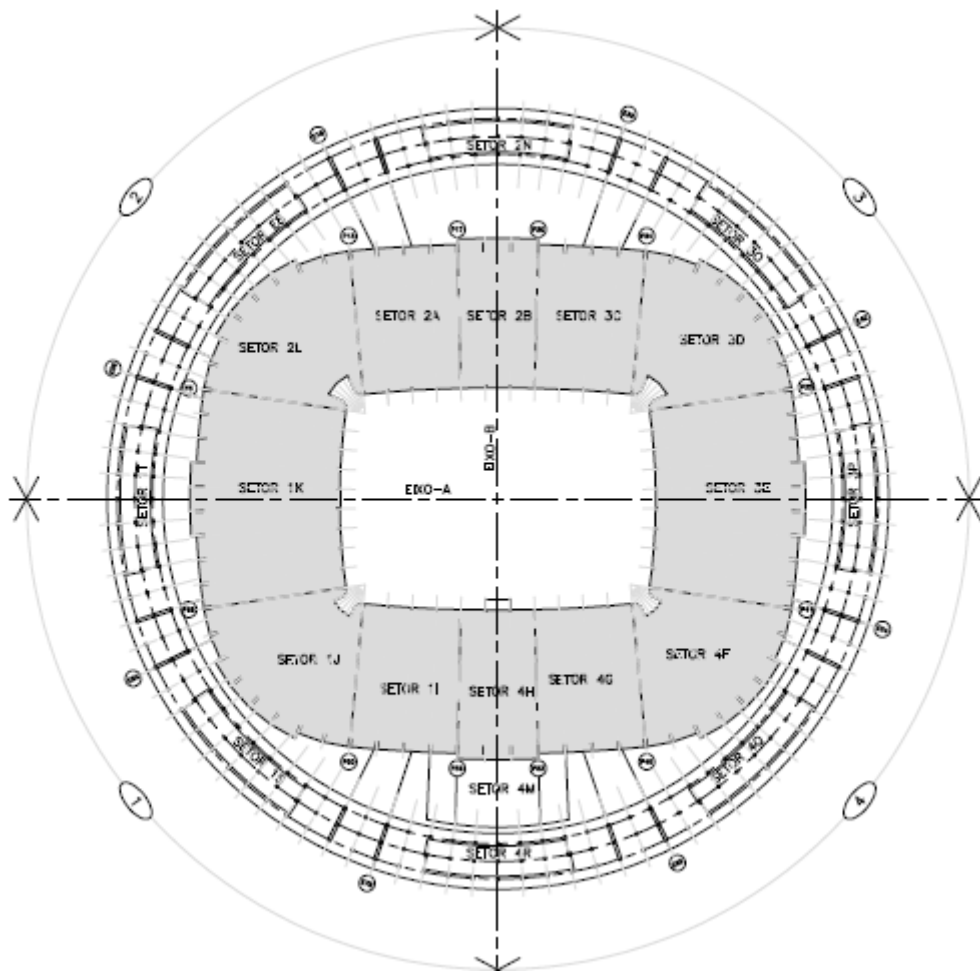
Planta da Estrutura – Estádio Nacional
